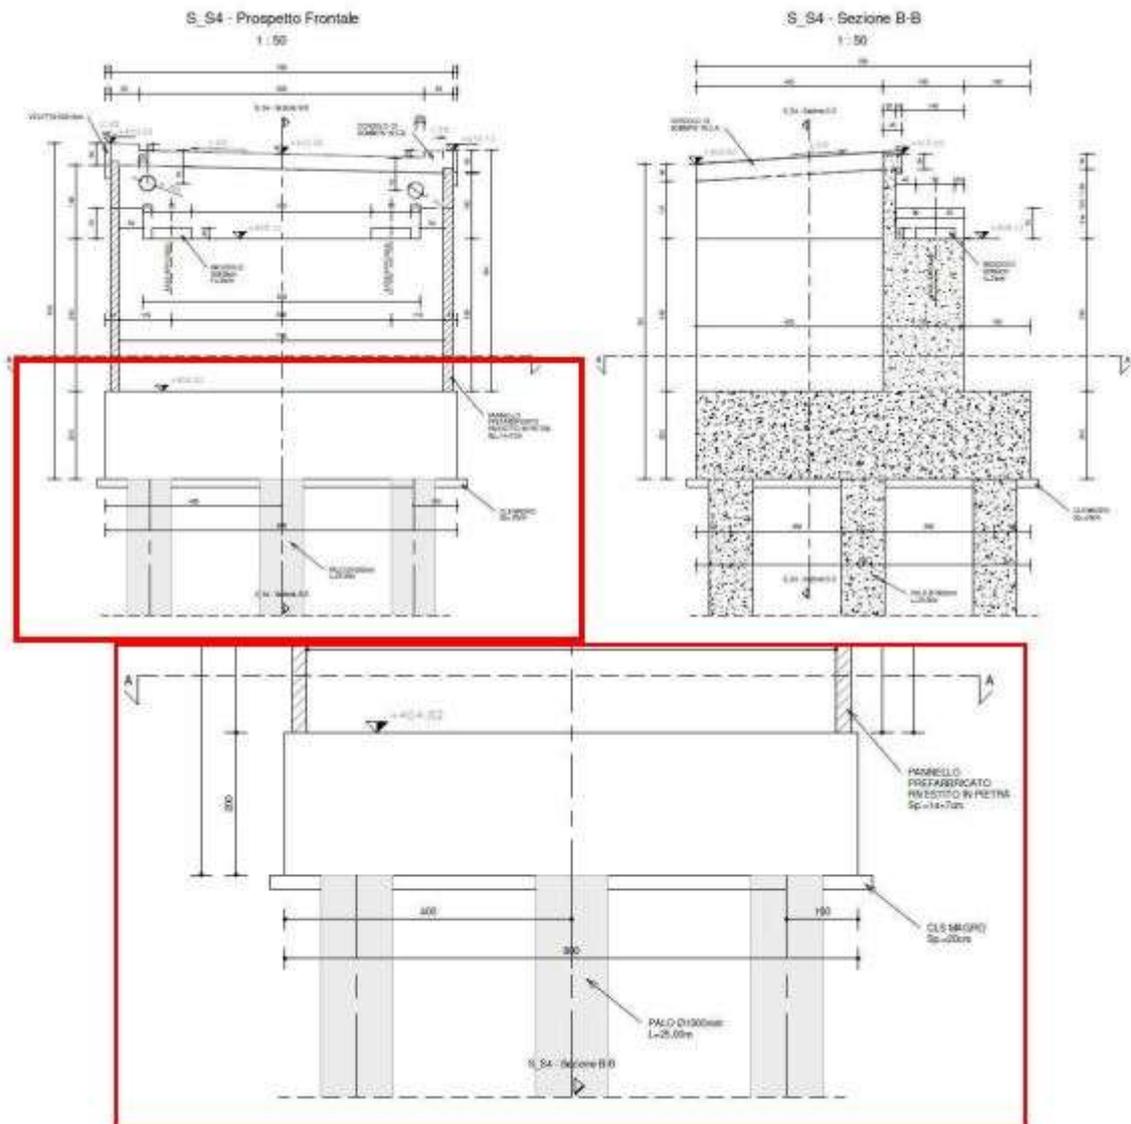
Spalla S4 - prospetto, sezione e dettaglio fondamenta
